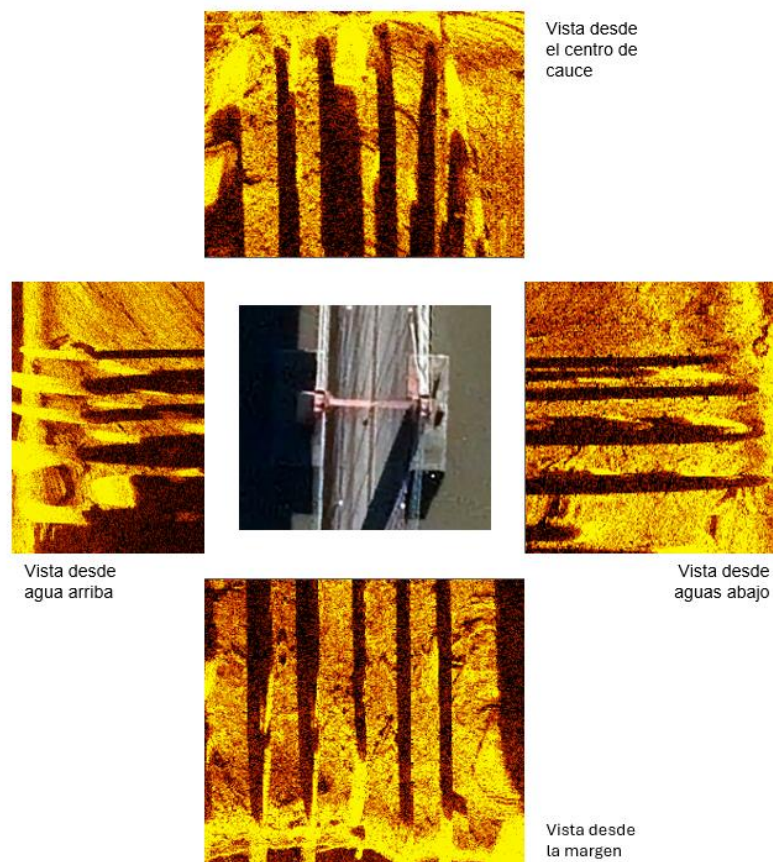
Imágenes de barrido lateral sobre las pilas del puente.
